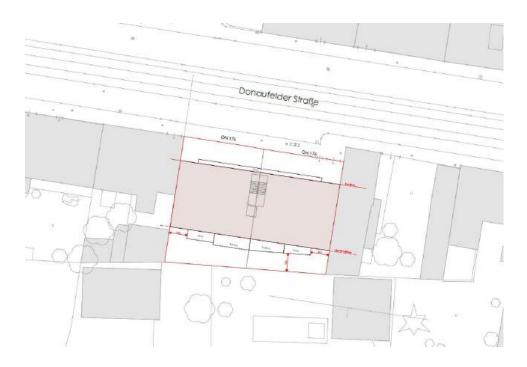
Lageplan 22. Donaufelder Straße 174-178
